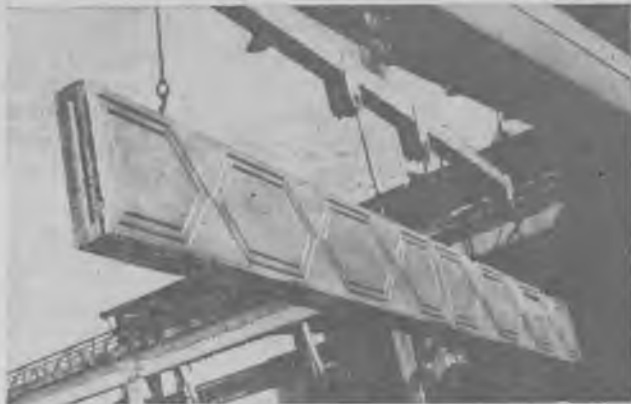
Наружная стеновая панель из шлакопемзобетона
